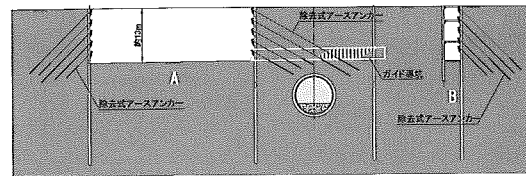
全体縦断面図(A:発進立坑, B:反力立坑)
